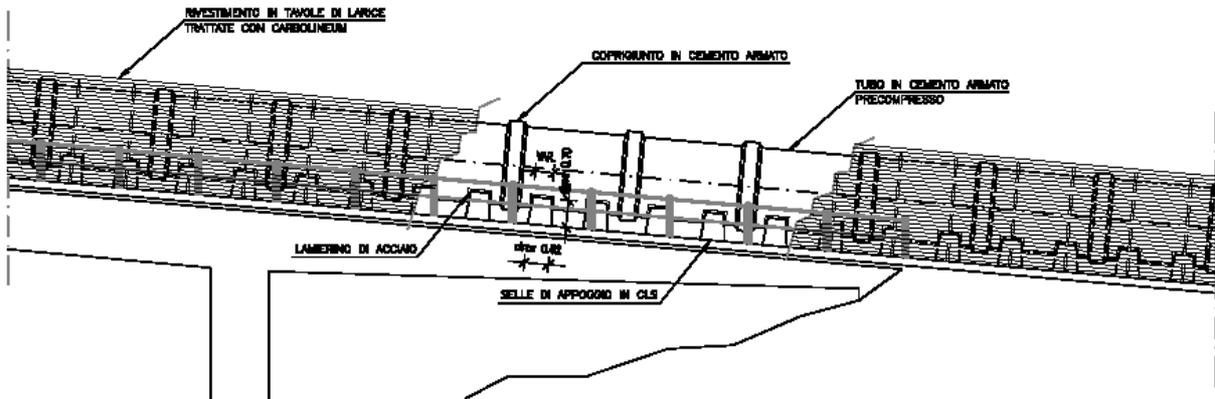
tratto all'aperto della condotta forzata in c.a.p. lungo il ponte tubo
